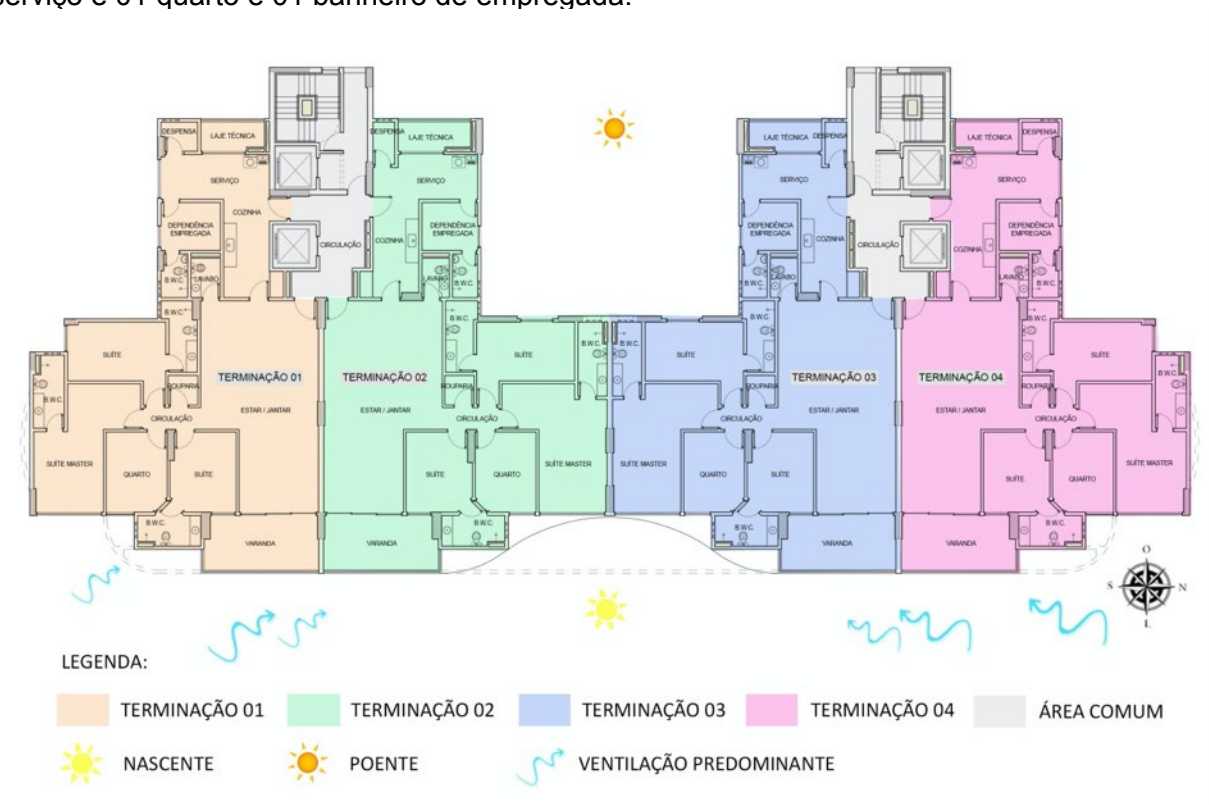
Planta baixa do pavimento tipo do edifício Genova, condomínio Riviera Del Mare
